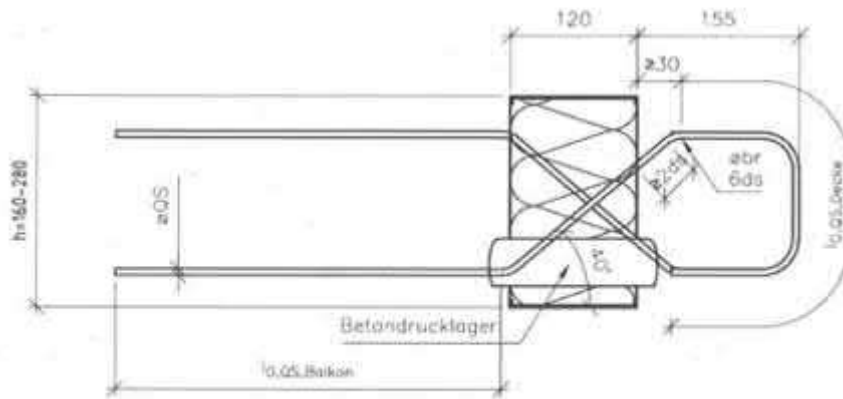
Elementschnitt ISOPRO® 120 – QQ/QQS Stabdurchmesser 6 – deckenseitig geschlaufte Ausführung Ausführung ISOPRO® 80 mit Stabneigung 45°
